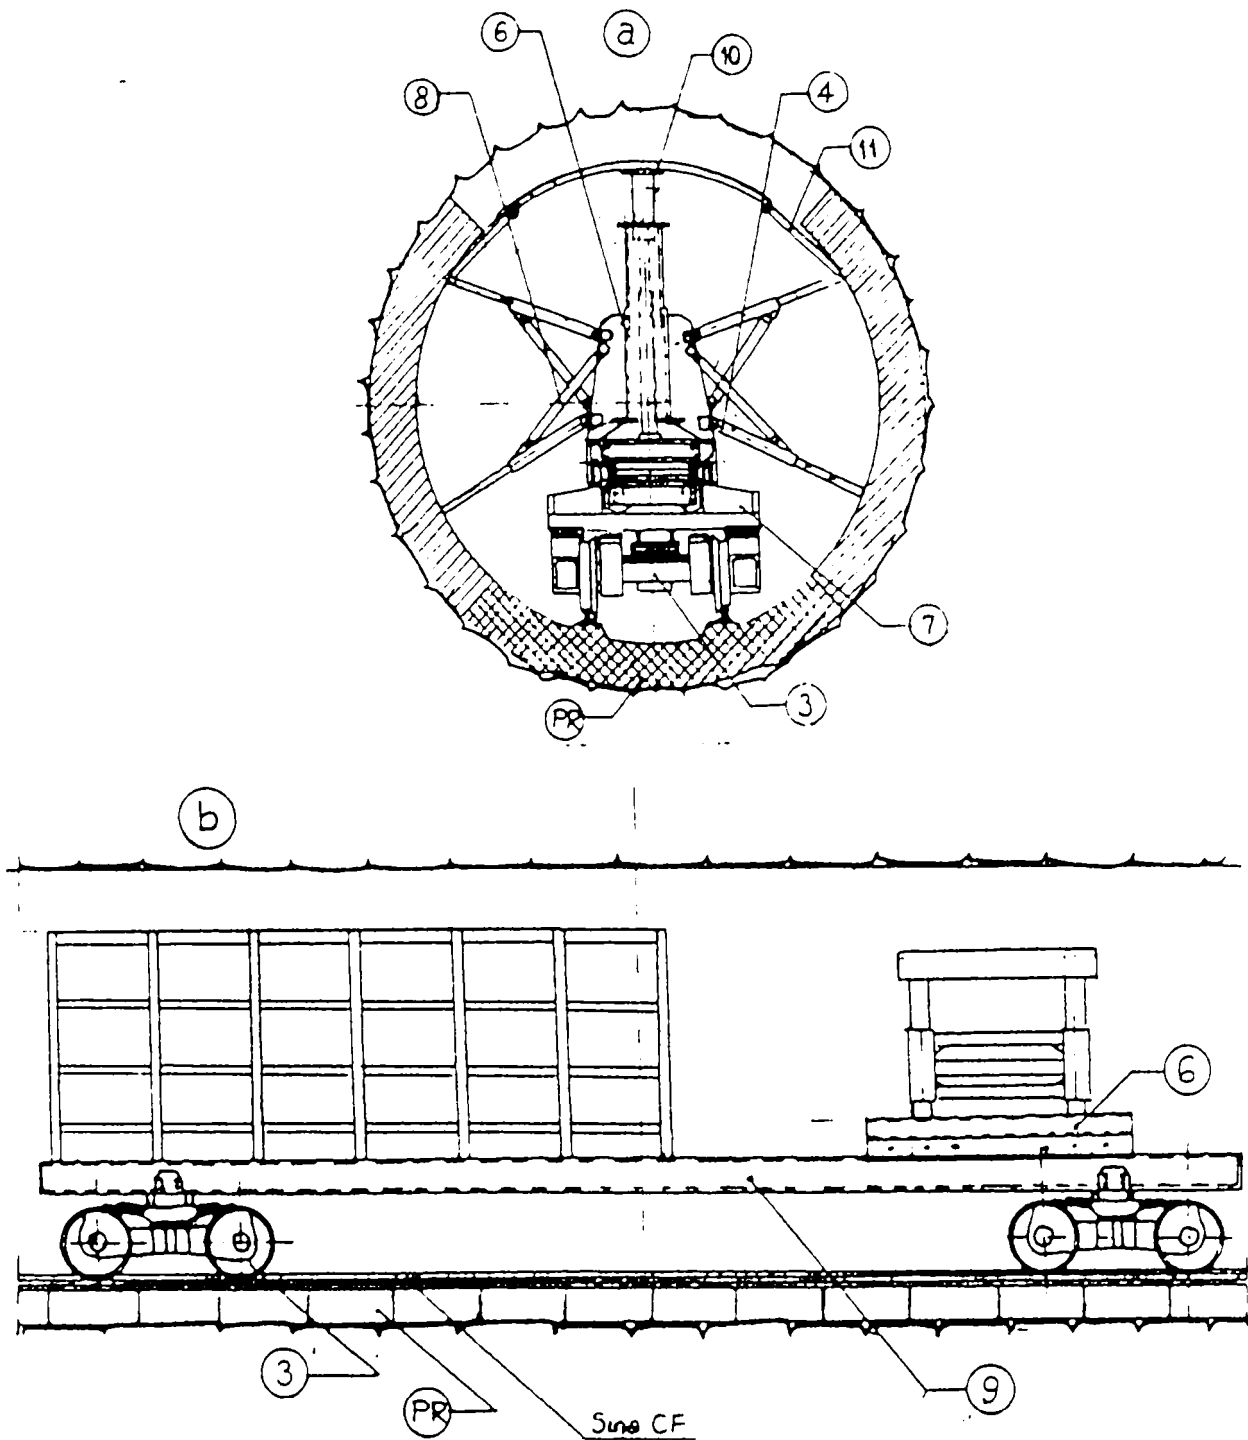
Cadrul port - cofraj modificat : a) secțiune transversală ;
